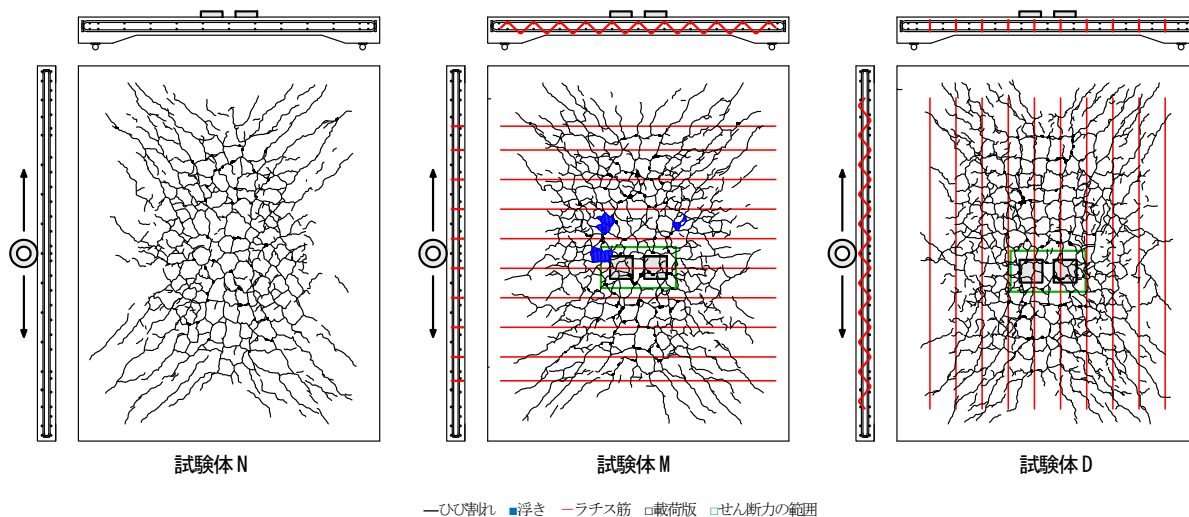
試験体下面ひび割れ図(170kN_7万回)
